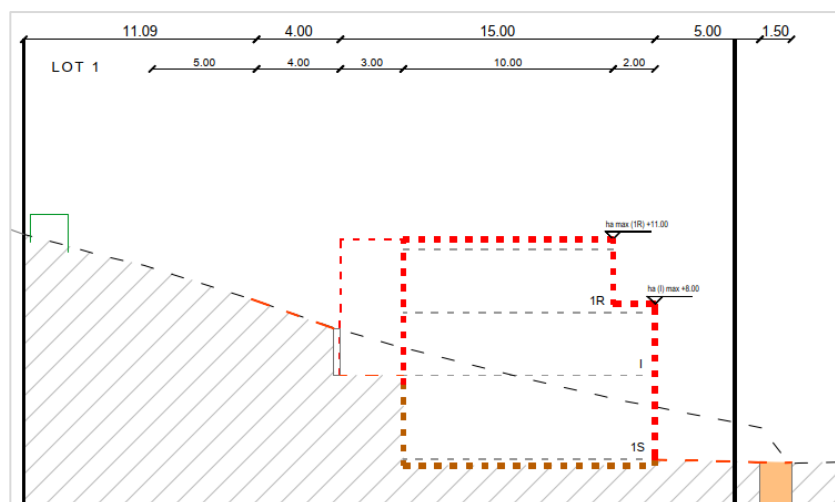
Coupe-Type - aménagement d'une ouverture sur la façade arrière (Source: BEST)
